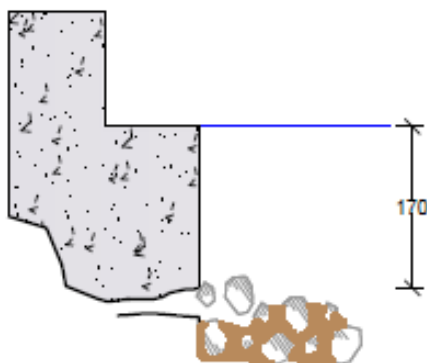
Coupe transversale de l'ouvrage au droit de l'abscisse 495.5 m caractérisée par une résurgence en pied de mur
